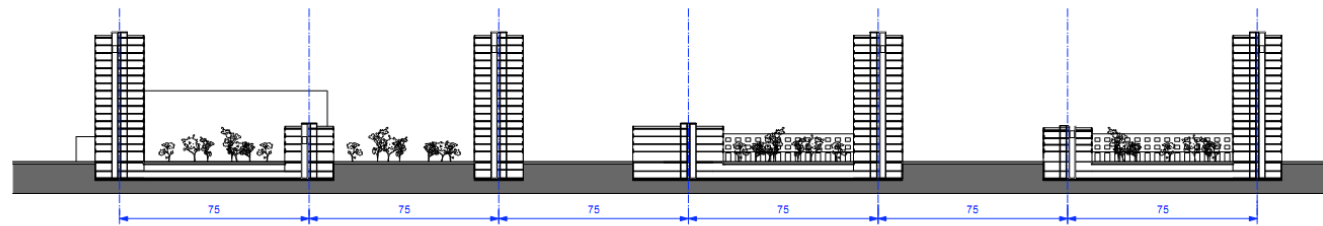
Schema bebouwing stedelijk plateau (idem)
